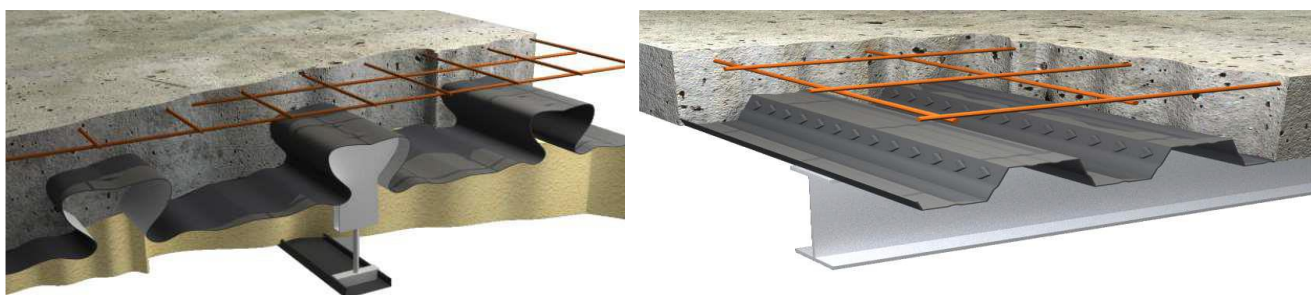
Приклади сталезалізобетонних перекриттів
